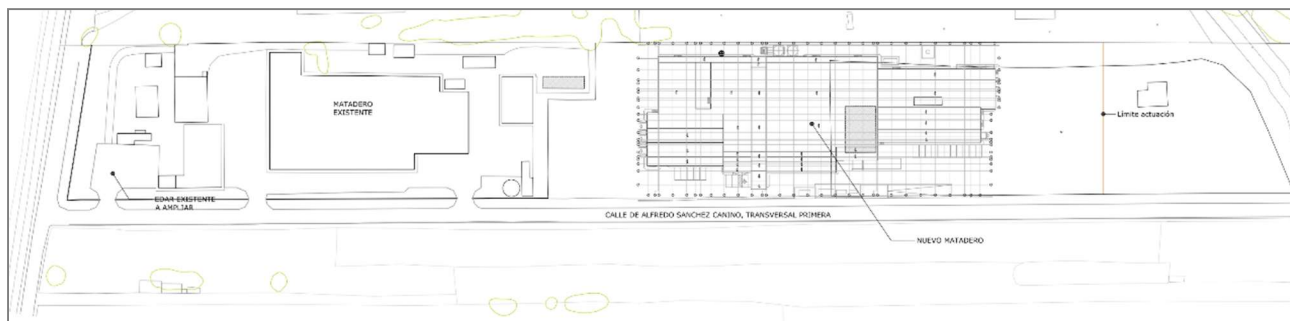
Planta de localización del Nuevo Matadero Insular respecto al existente. Fuente: Proyecto Definitivo de Ejecución
